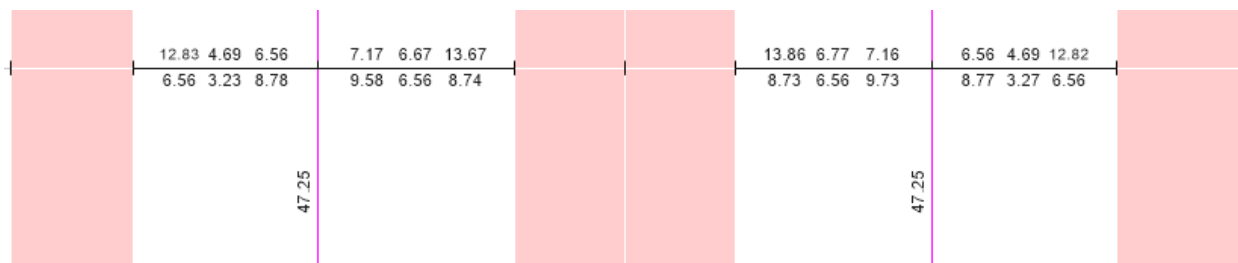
Acero Requerido por momentos en Vigas 7° Piso
